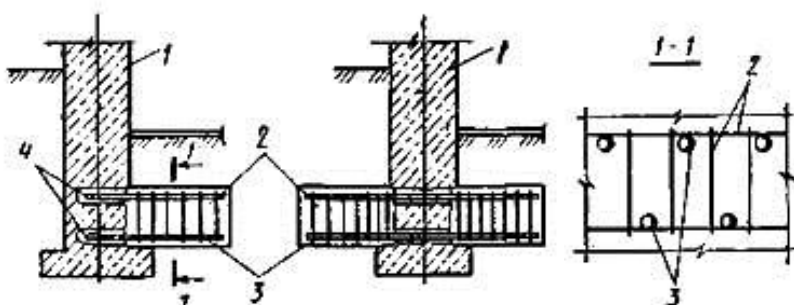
Усиление ленточных фундаментов наращиванием:
